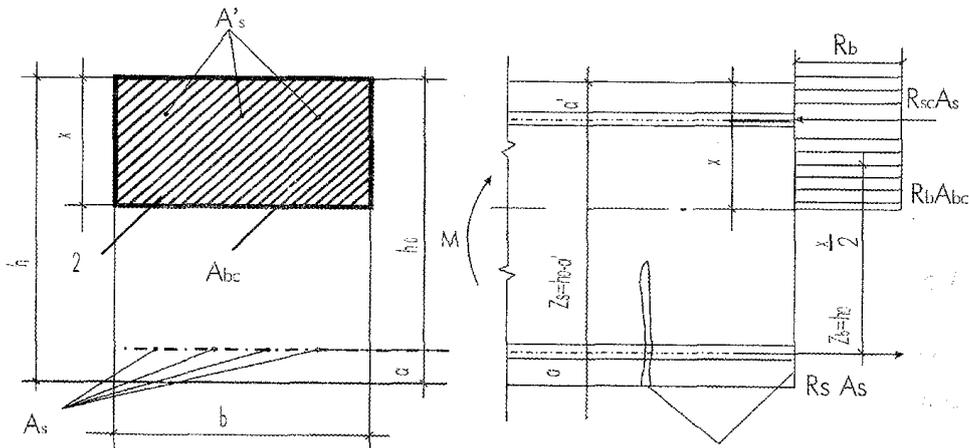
Расчётная схема изгибаемого элемента с двойной арматурой
